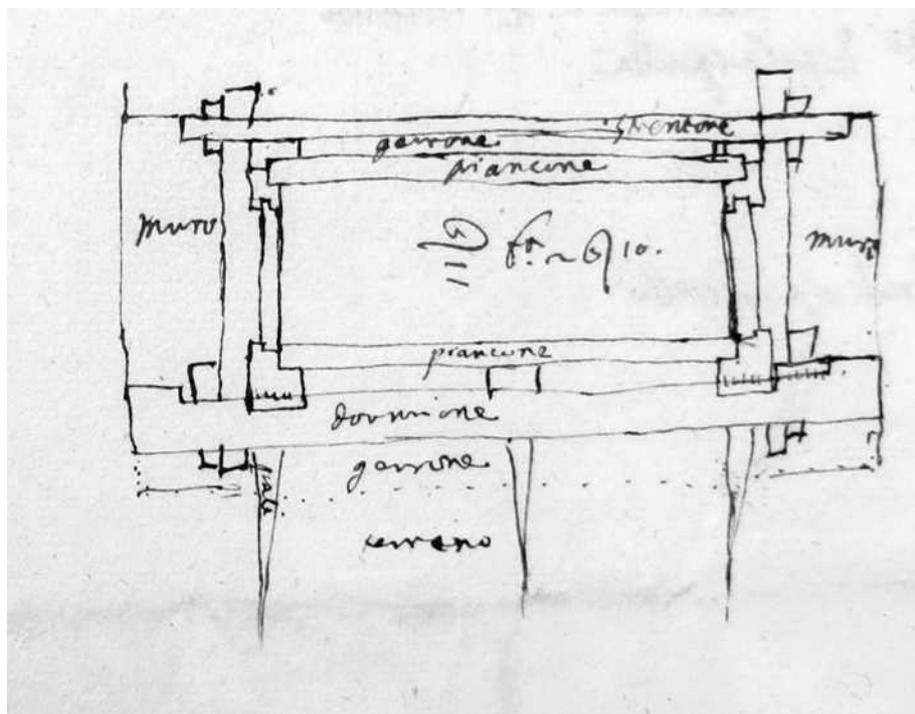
1625 - Progetto di tomba sotto il Lambro, sezione verticale.
